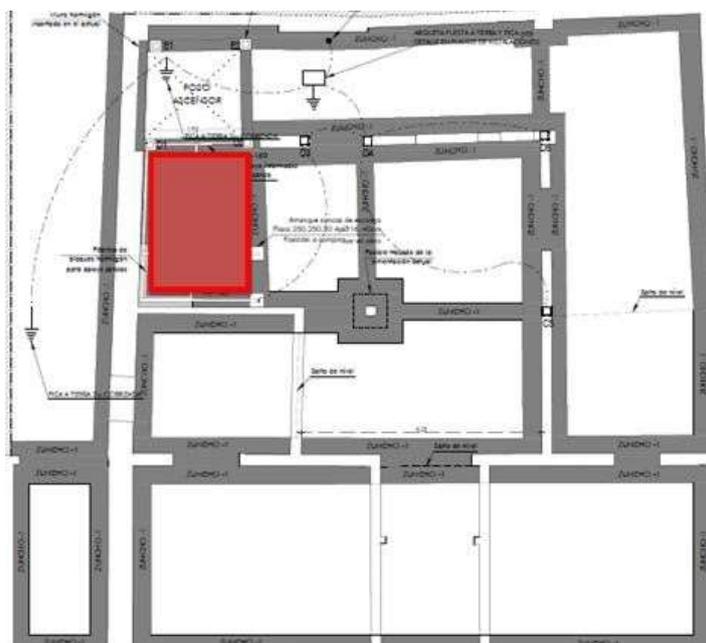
Planta de refuerzo de cimentación. En rojo caja de las escaleras.
